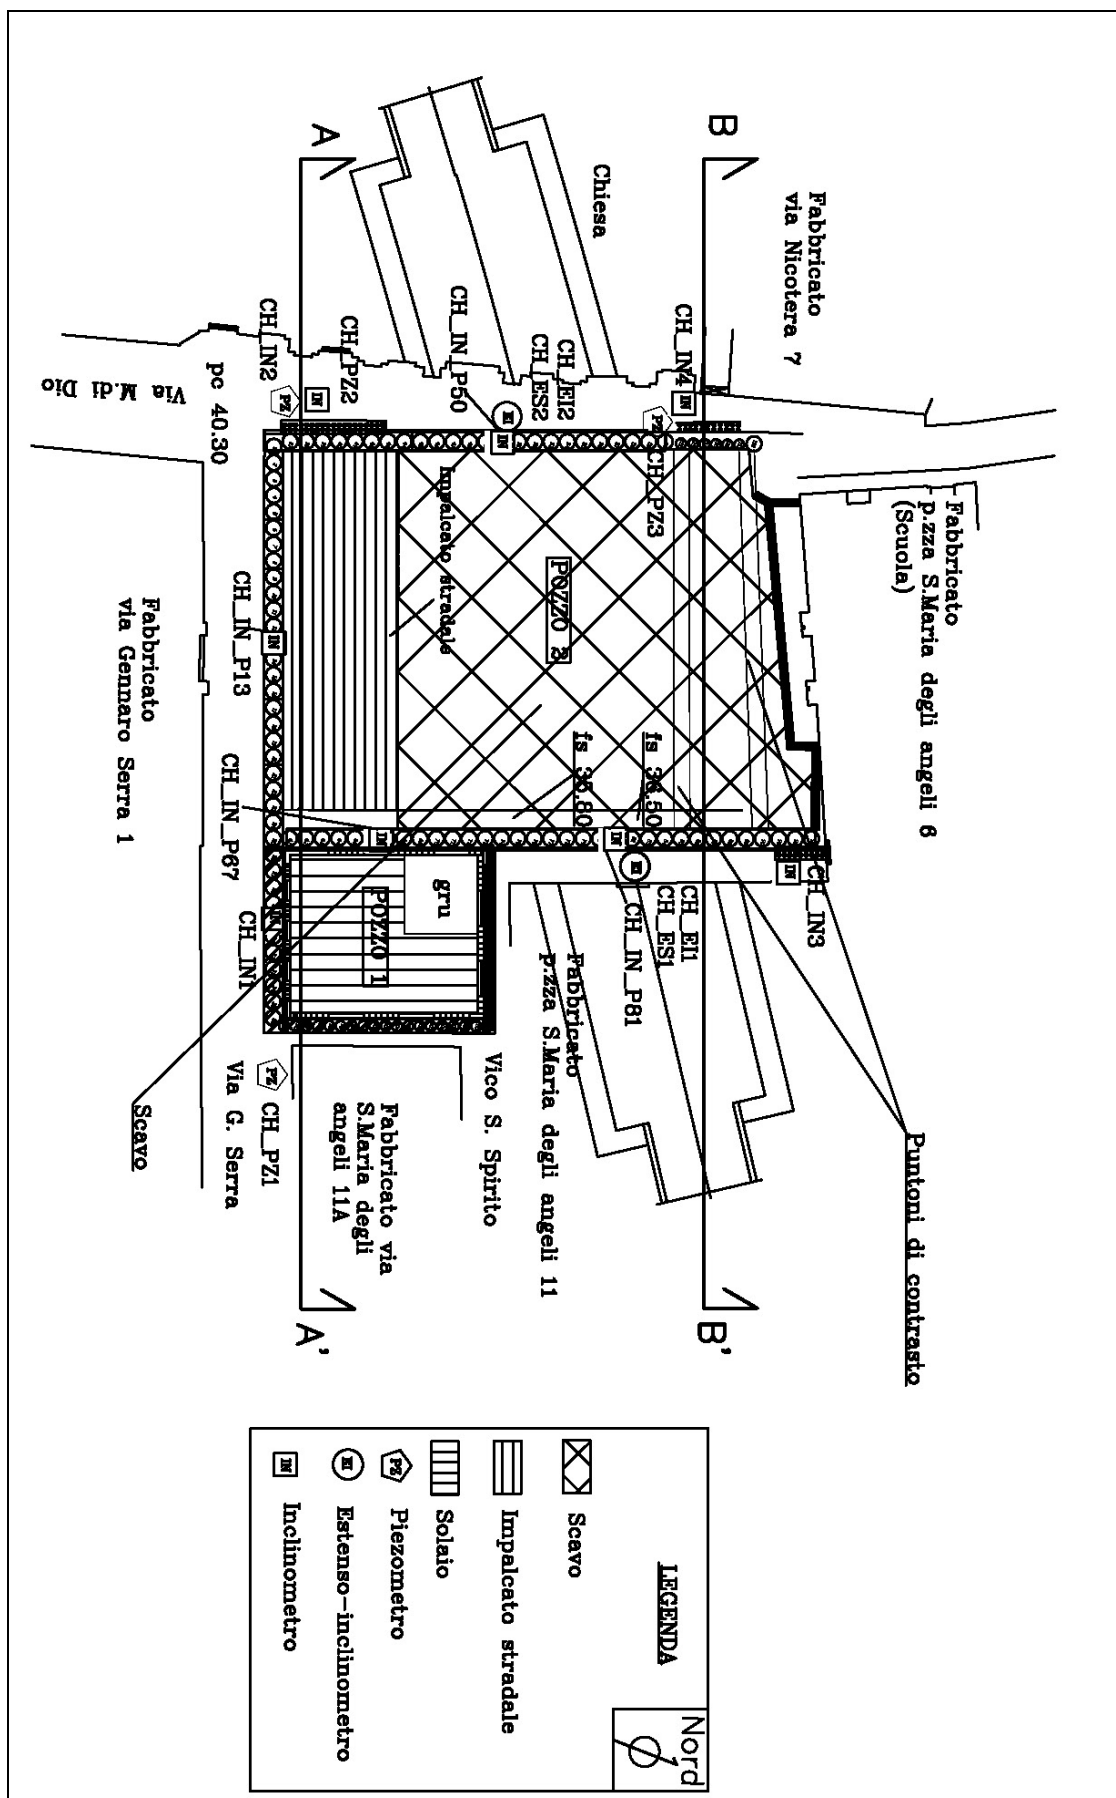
Planimetria pozzo stazione, raffigurante la suddivisione in aree di lavoro.
